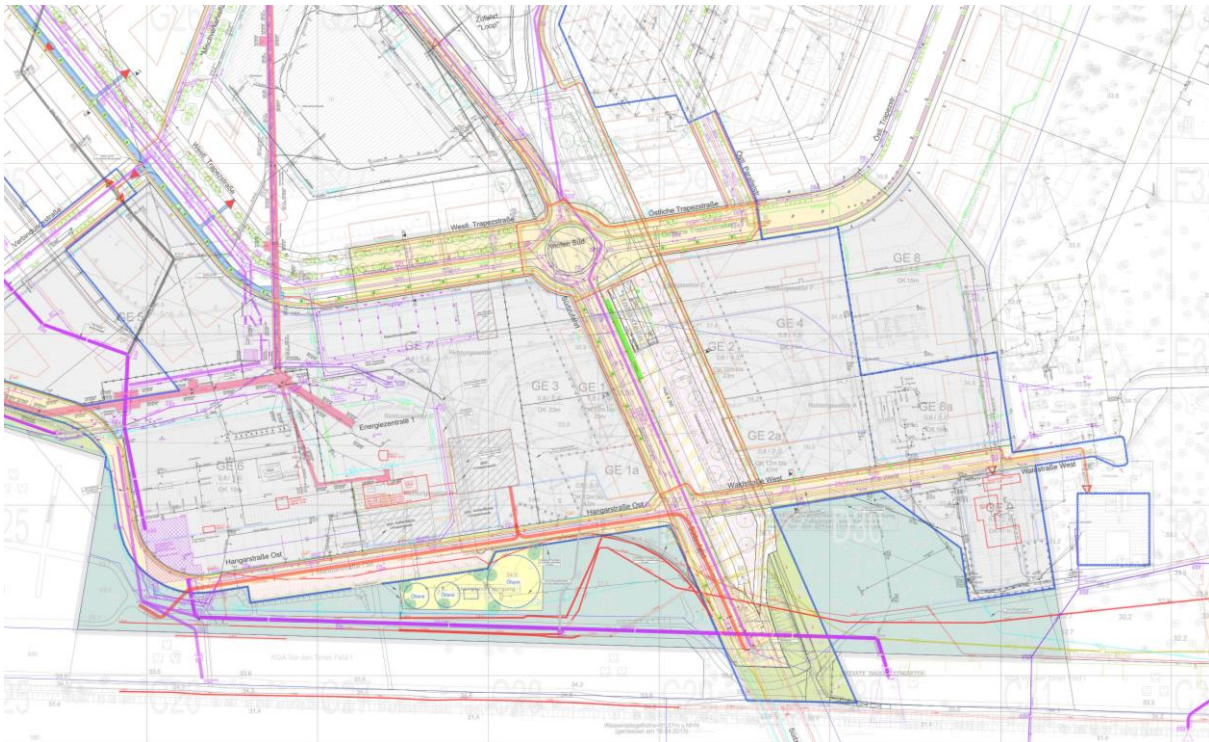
Überlagerung vorhandener und geplanter Leitungsführungen mit dem Bebauungsplan 12-50c
